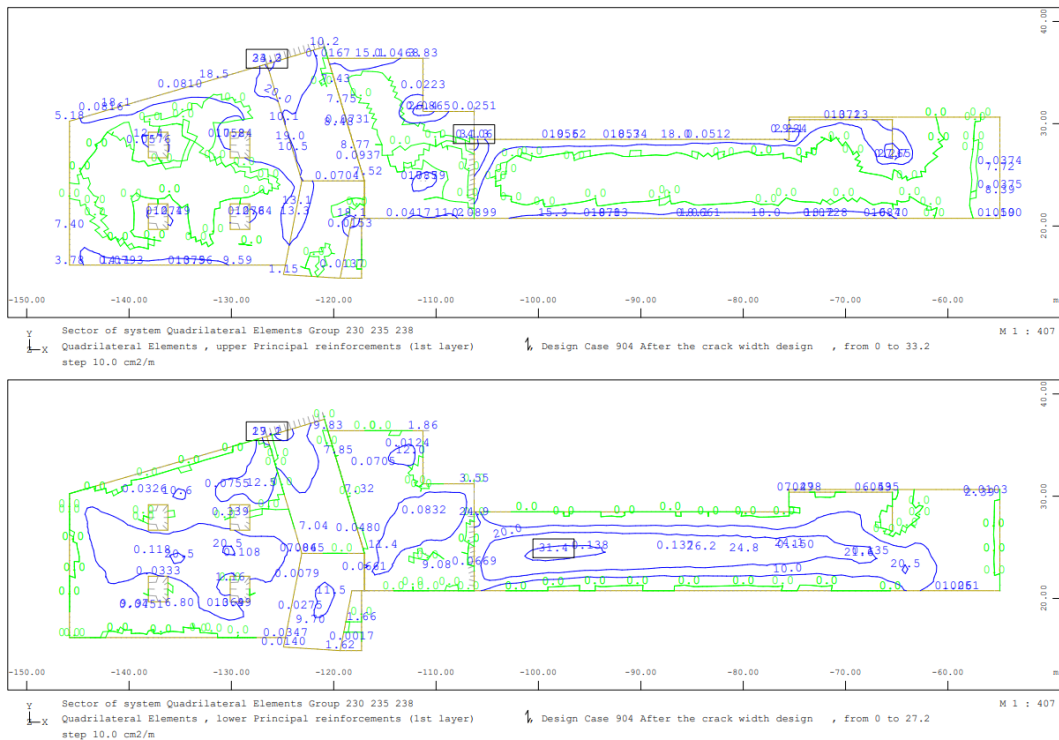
Armadura principal na face superior (sup.) e inferior (inf.) – laje de cobertura – acesso Norte - ELS
